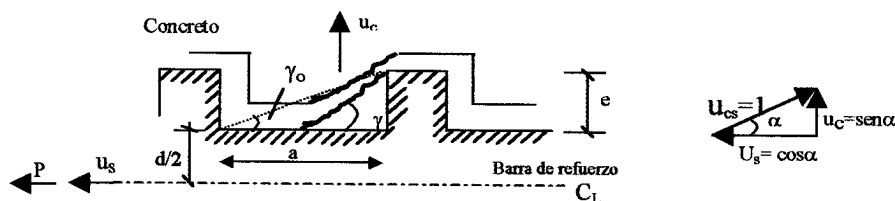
Mecanismo de falla local de una barra de refuerzo con estrías (Nielsen[16])
